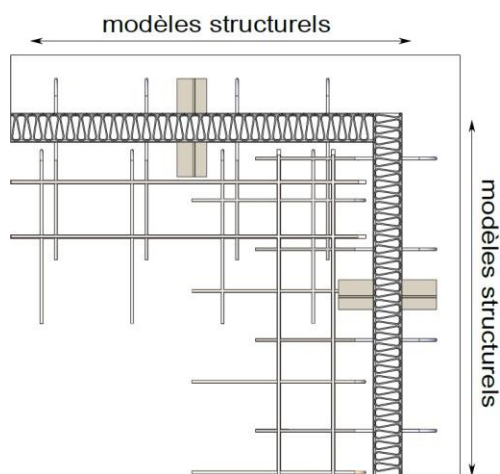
Exemple de calepinage au départ d'angle (vue en plan)
